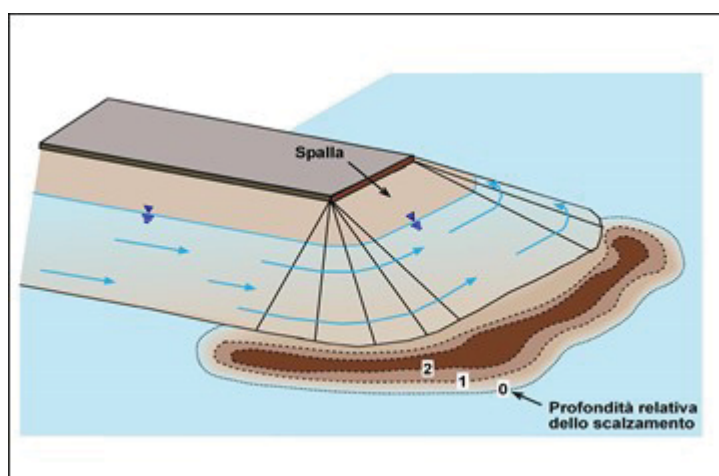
Schema del fenomeno di scalzamento in corrispondenza di una spalla.
